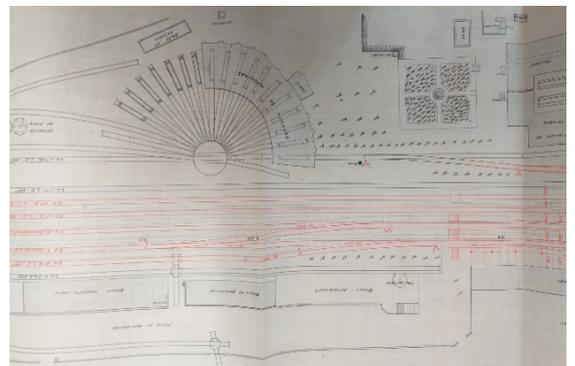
Planta modificada del edificio de viajeros a 13 de junio de 1918
